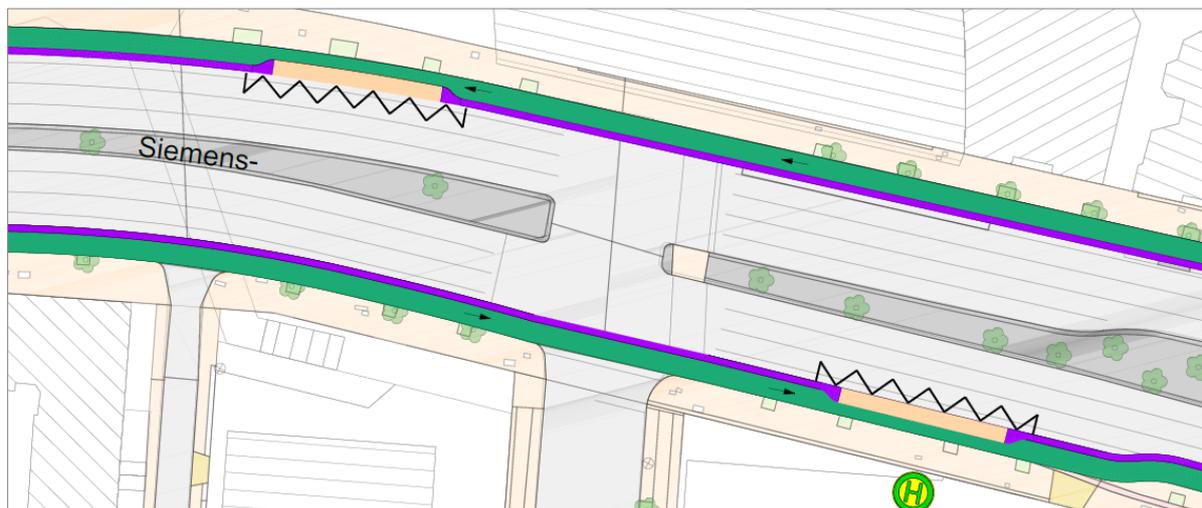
Siemensdamm – Ausschnitt Lageplan
